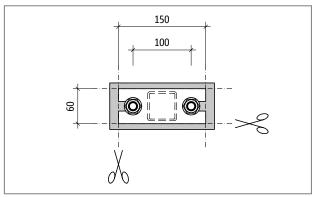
Schöck Isokorb® T Typ S-V: Maße nach Abschneiden des Dämmkörpers
